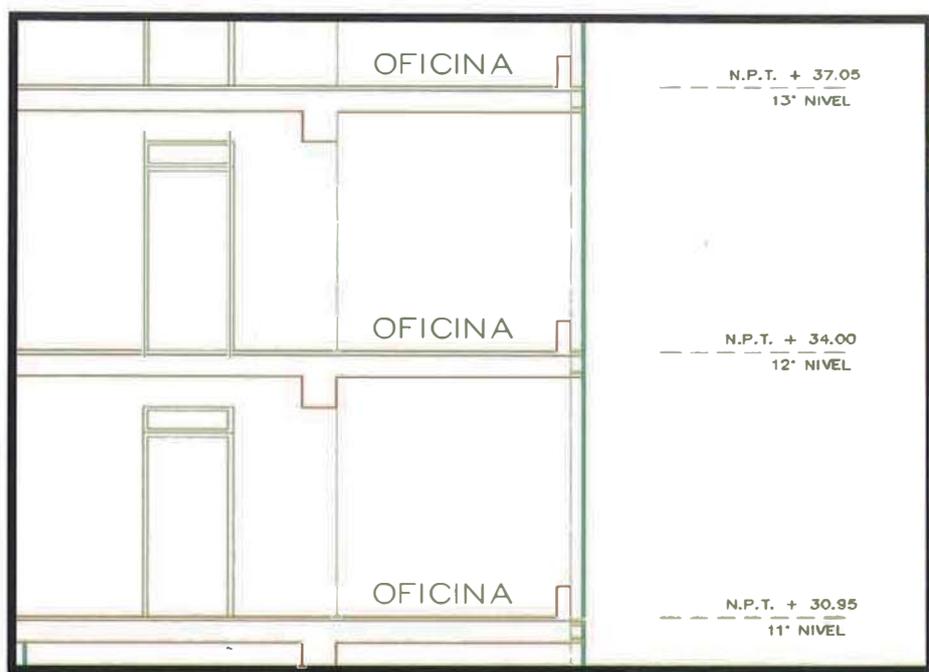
Corte general de arquitectura actualizado - Con alféizar en fachada.
